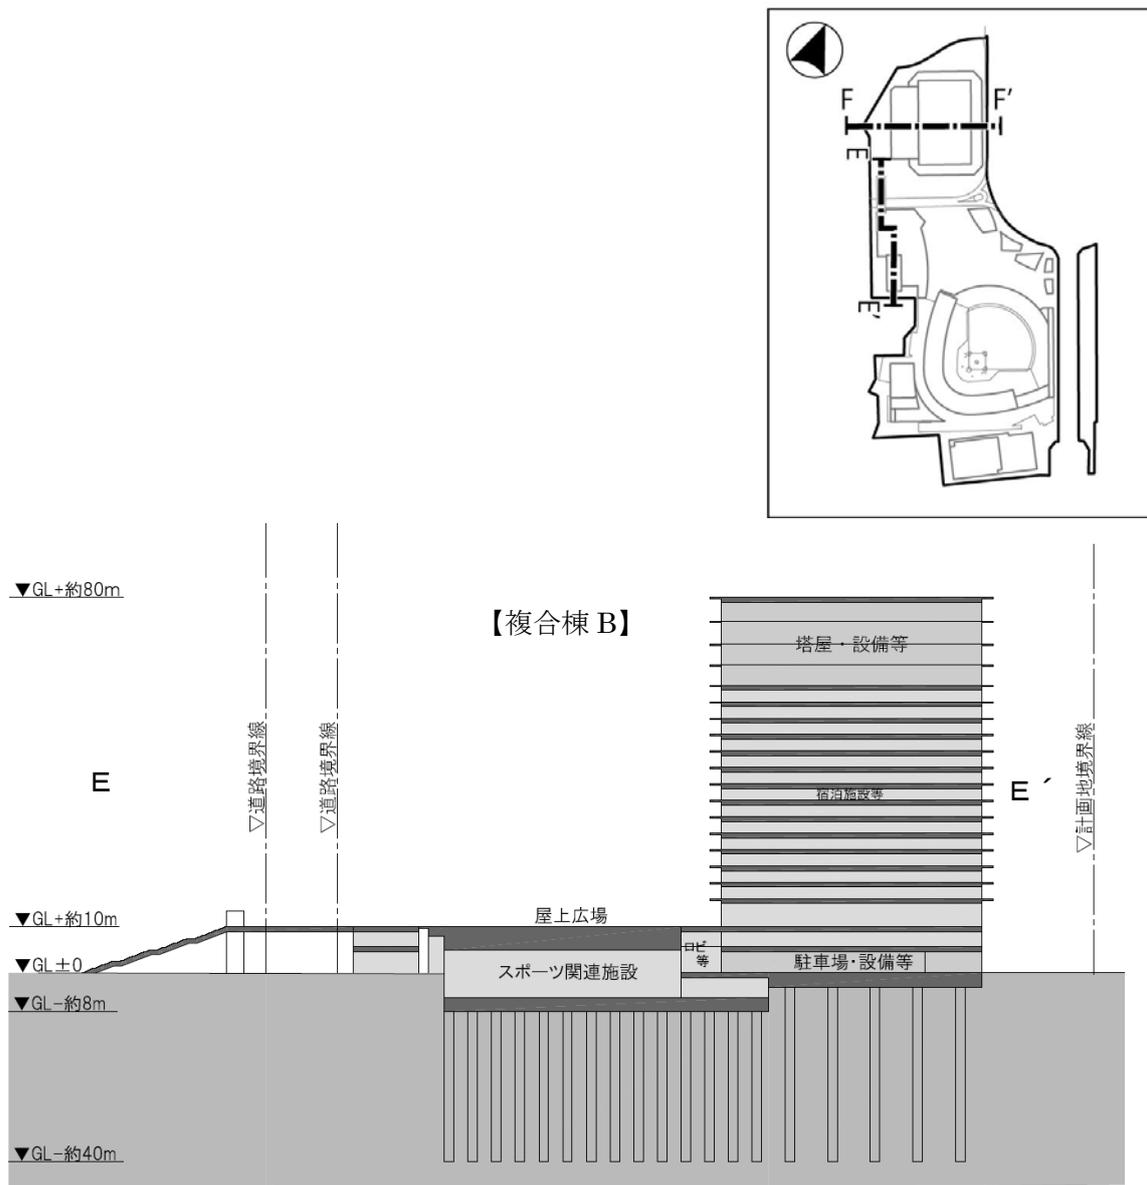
(1) 断面図(E-E') (変更後) S=1/1,600
